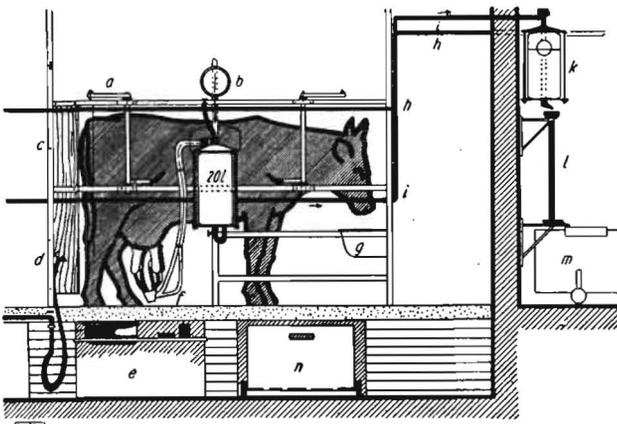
Melkanlage für 60 Kühe mit Milchbehandlungsraum. Einbau in einen vorhandenen Stall
